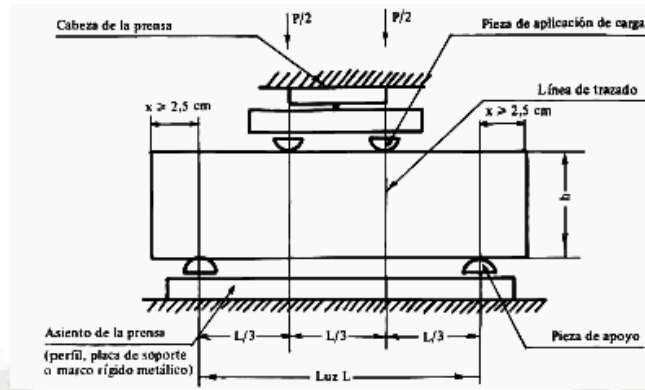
Máquina de ensayo, para vigas a flexión.
